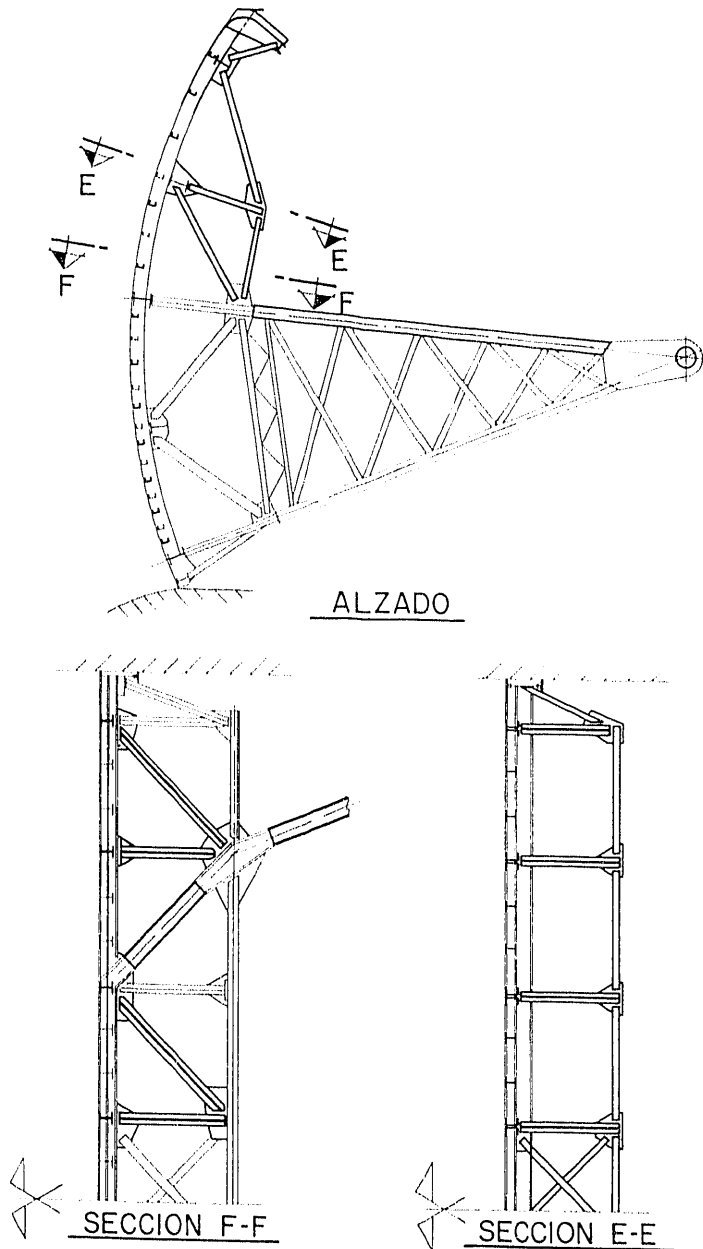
Salto de Villalcampo. Disposición esquemática de la compuerta recrecida.
